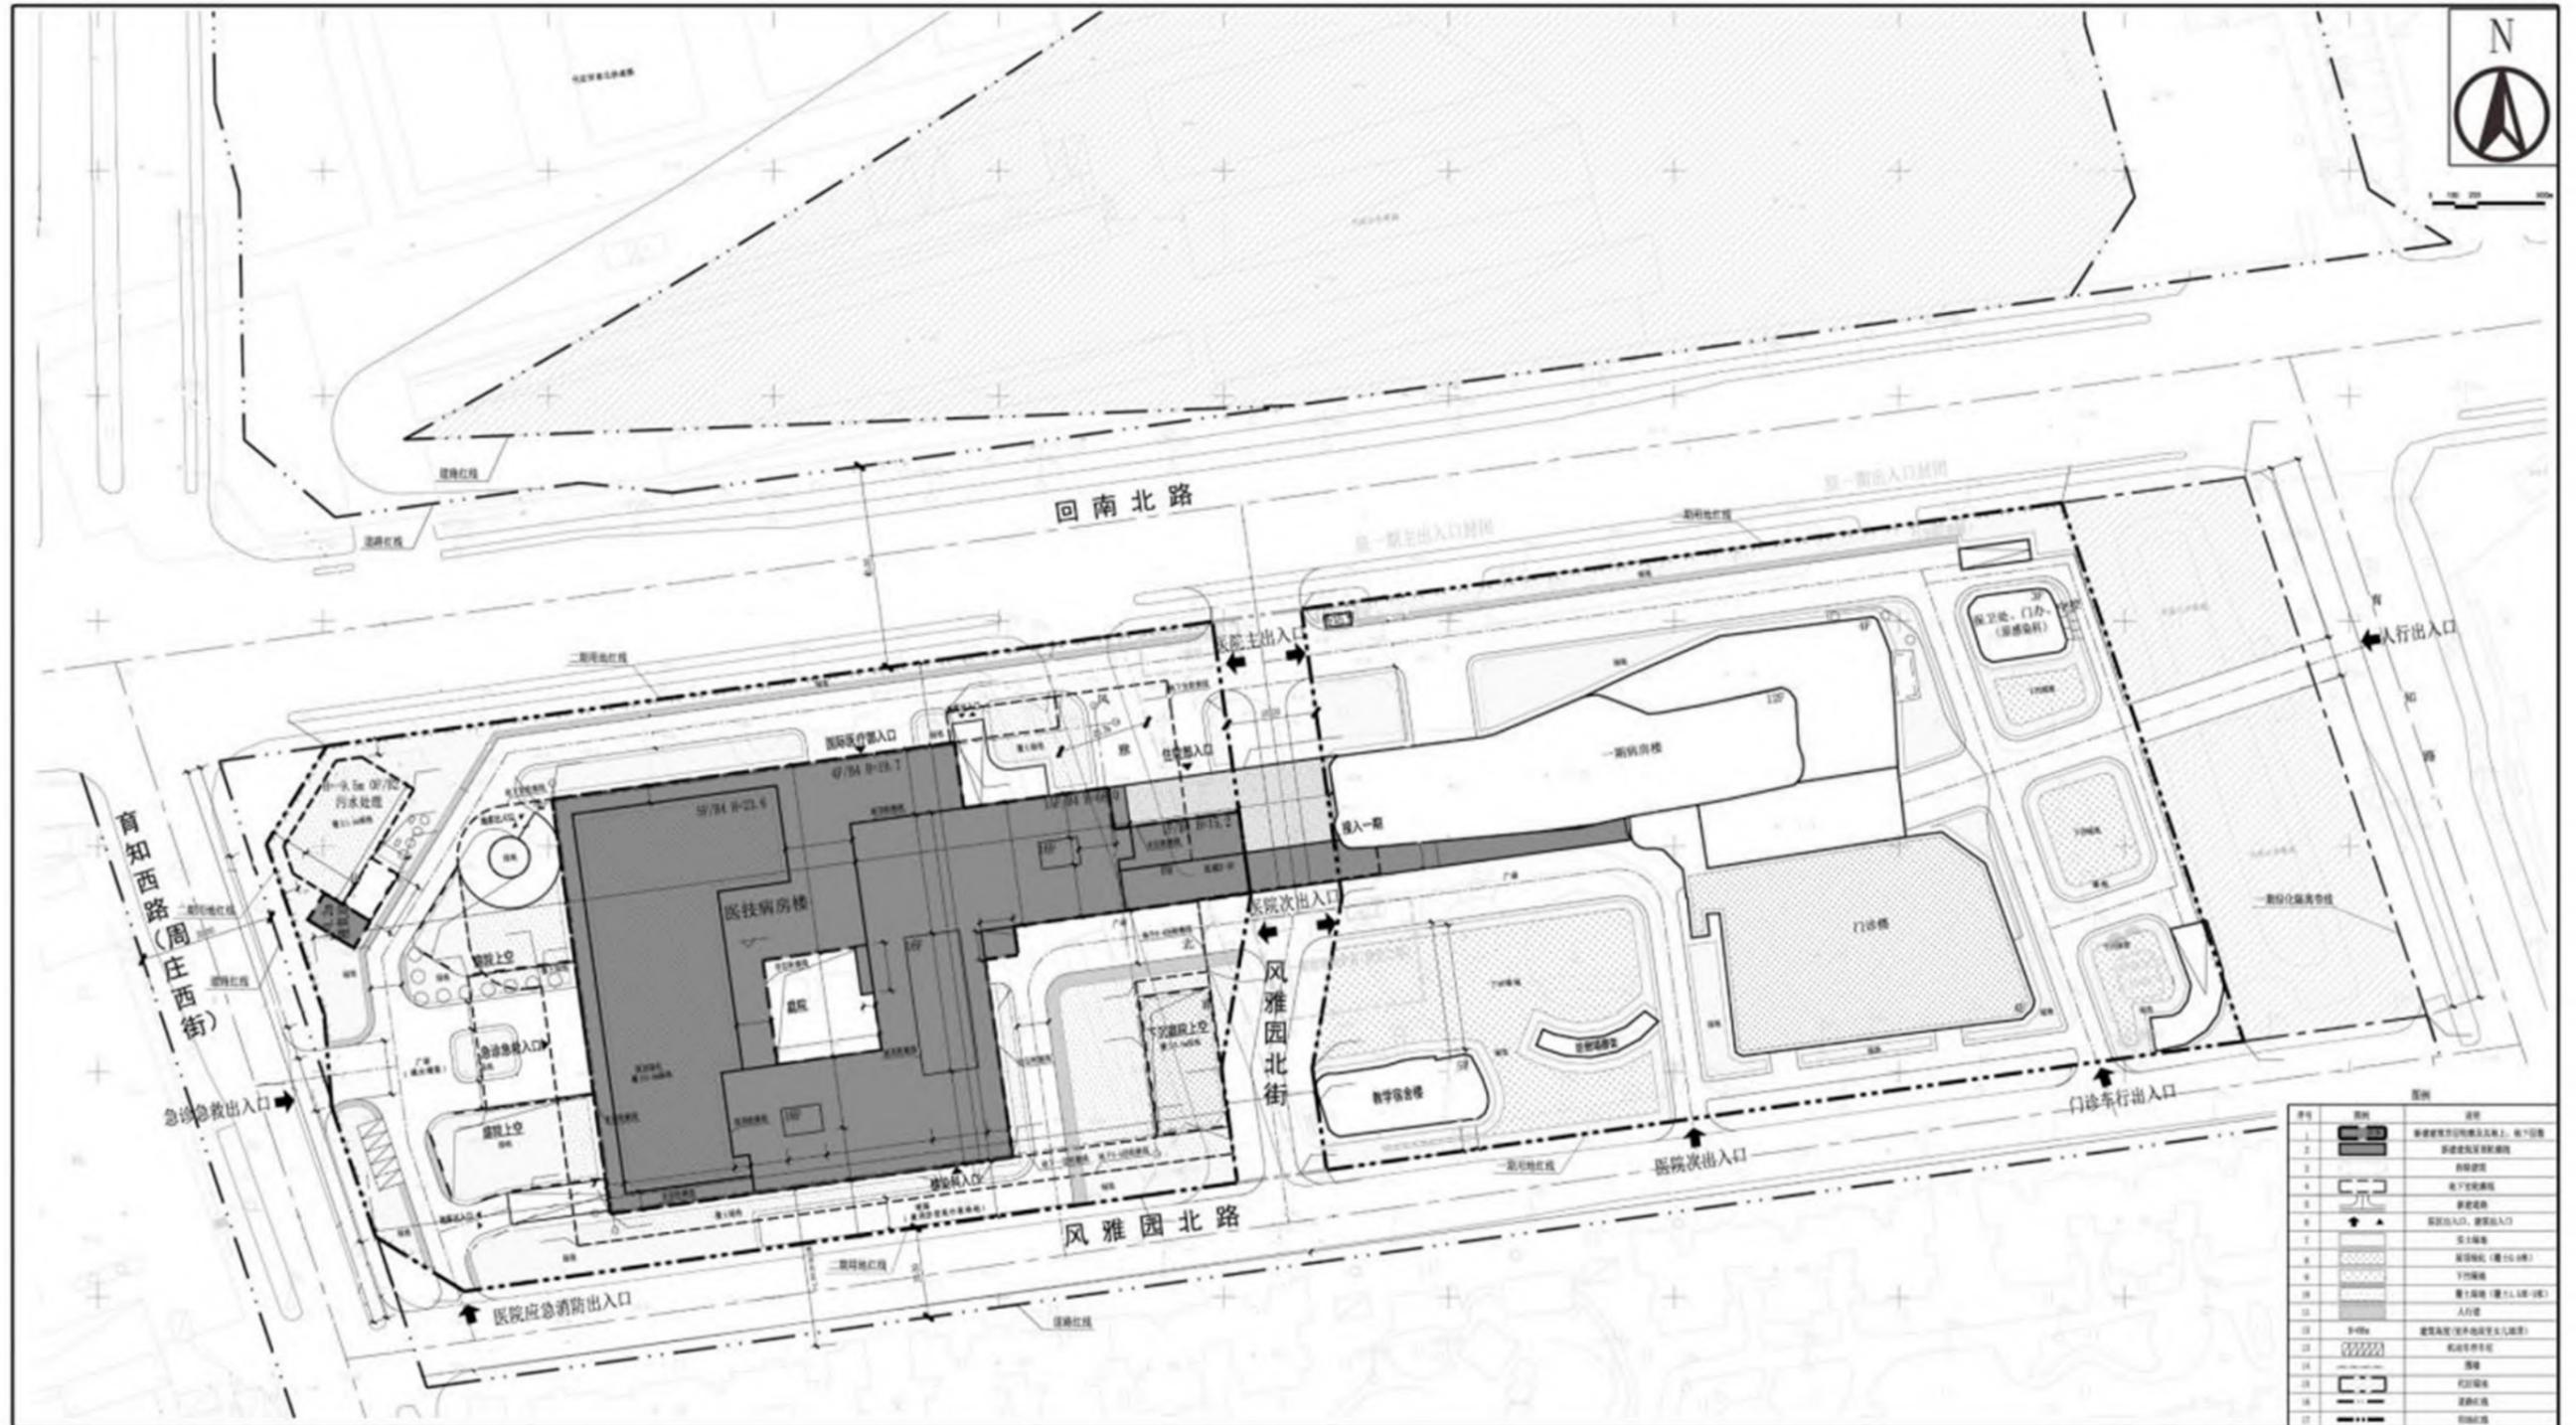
北京积水潭医院回龙观院区总平面布置图
